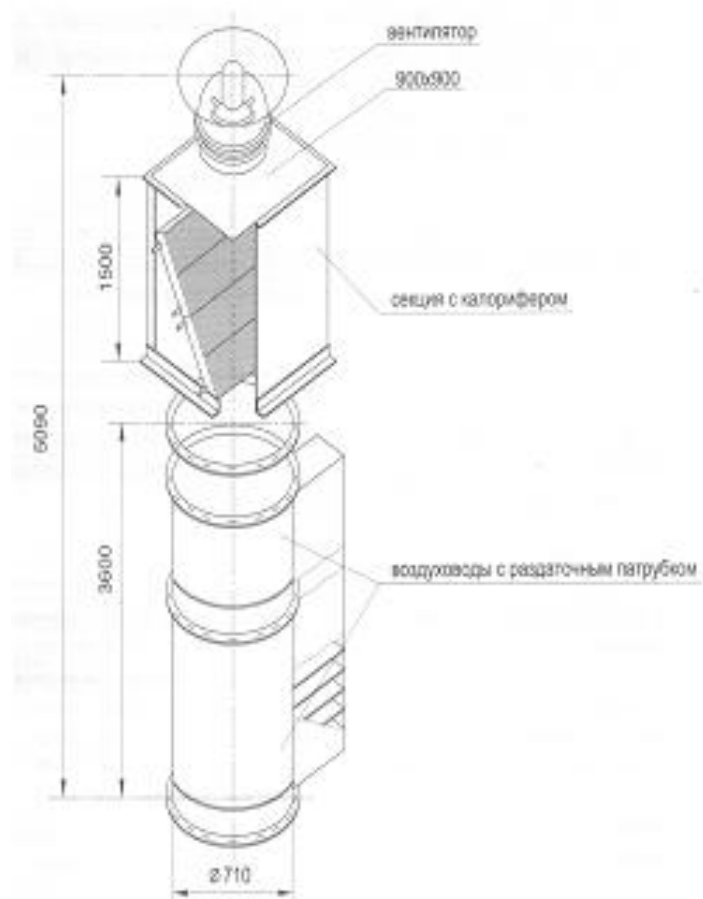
Конструкция несущего стояка воздушной завесы заводского изготовления
